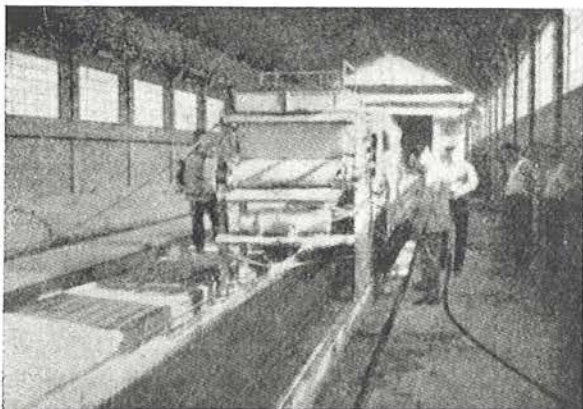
Máquina Weiler para fabricar vigas pretensadas con encofrado deslizante.
